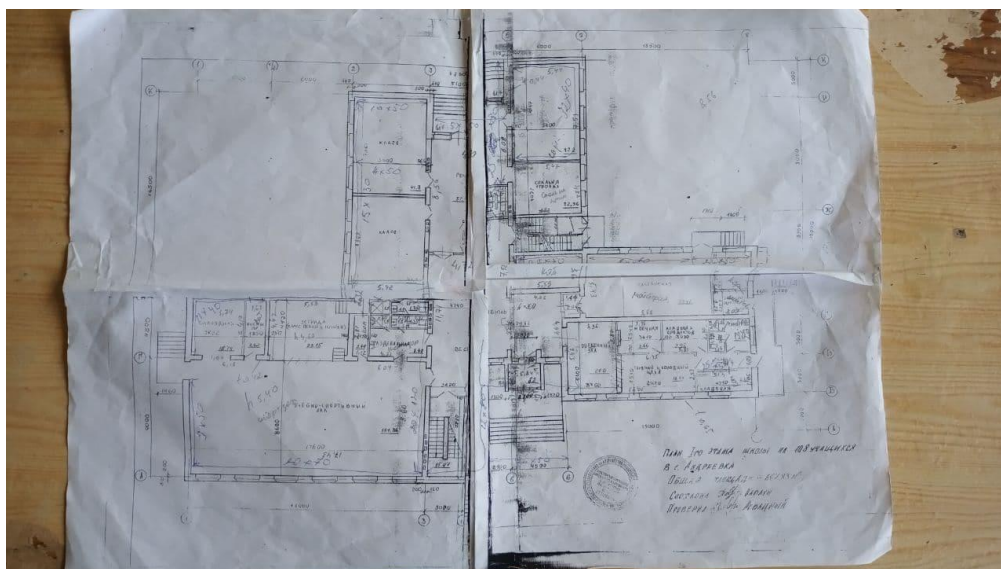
План будівлі 1-го поверху Андріївського ліцею.
